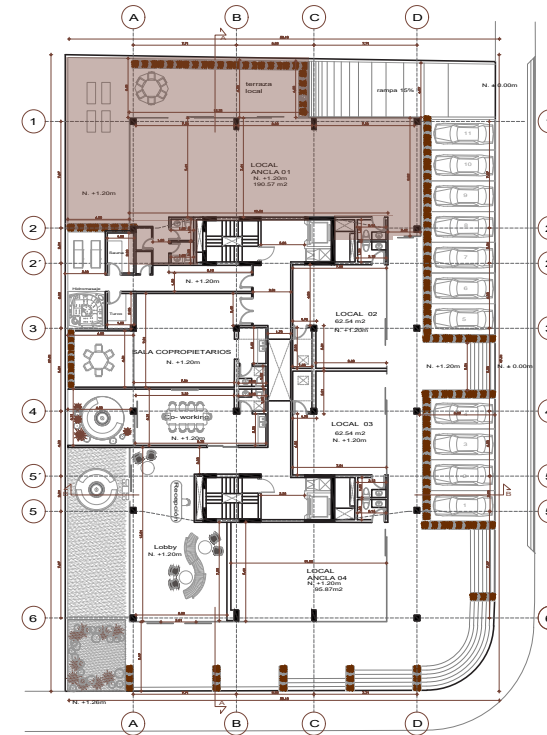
Planta Baja. Fuente: Arq. Juan Pablo Pineda
